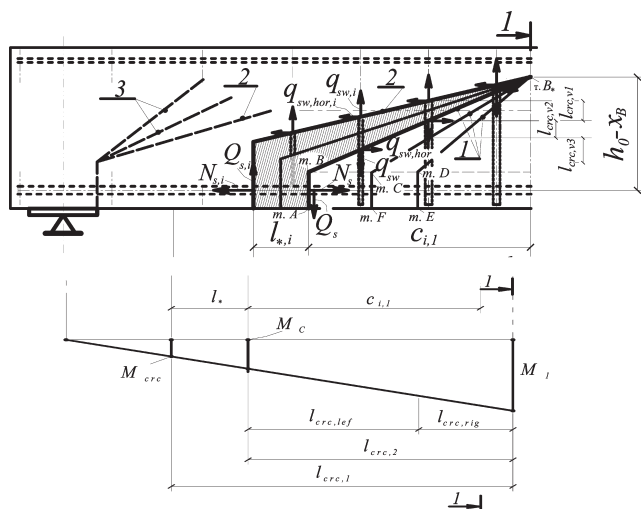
Расчетная схема для определения расстояний между трещинами и усилий в продольной и поперечной арматуре в смежных трещинах
